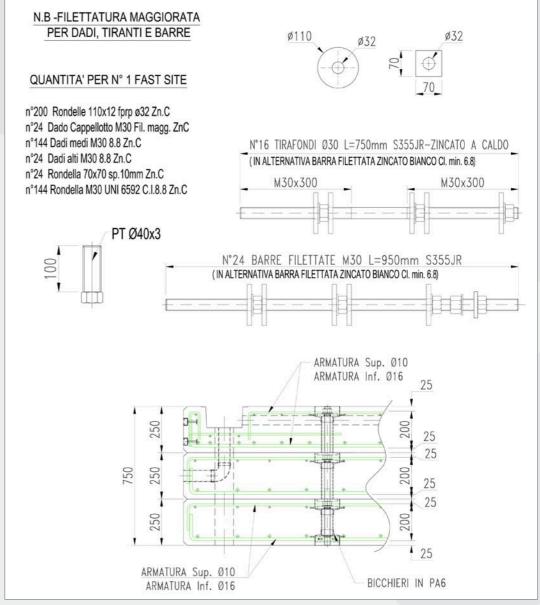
Collegamento moduli FAST SITE® SYSTEM 24
